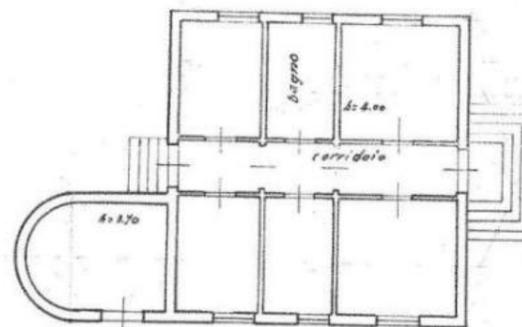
Fabbricato Part. 16. Planimetria Piano Terra
